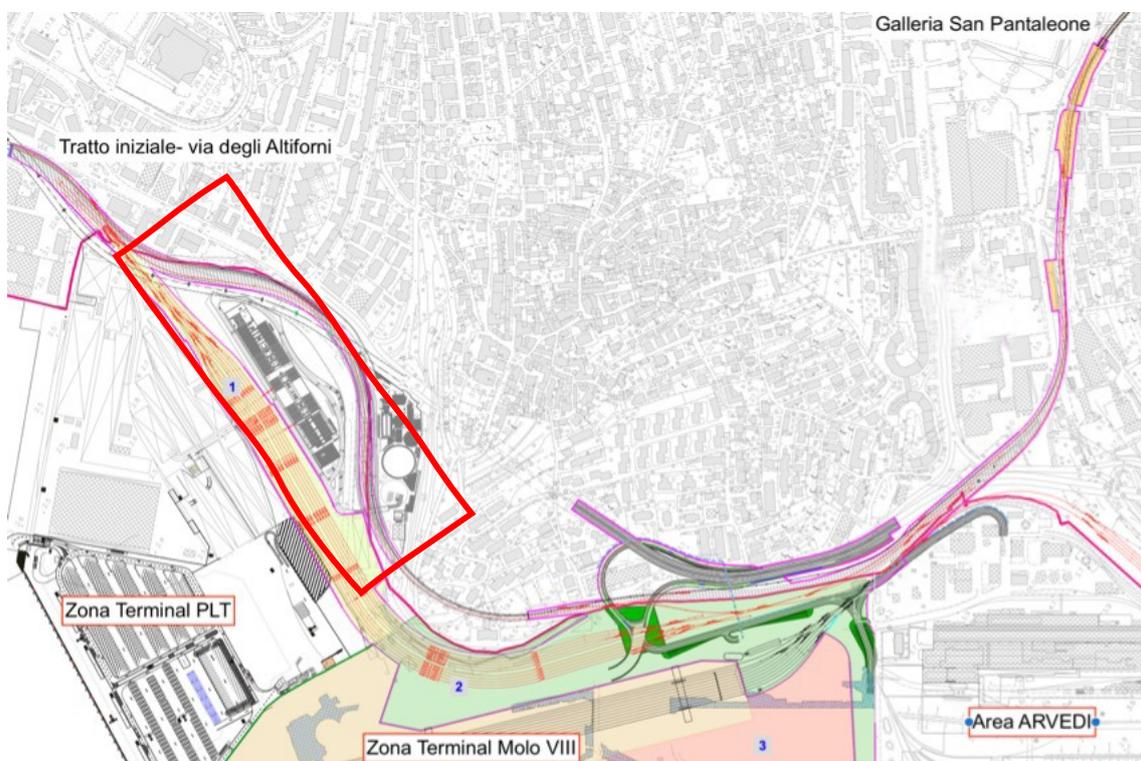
planimetria generale, con evidenziata la zona interessata dal rialzo della c.d. "linea bassa"
